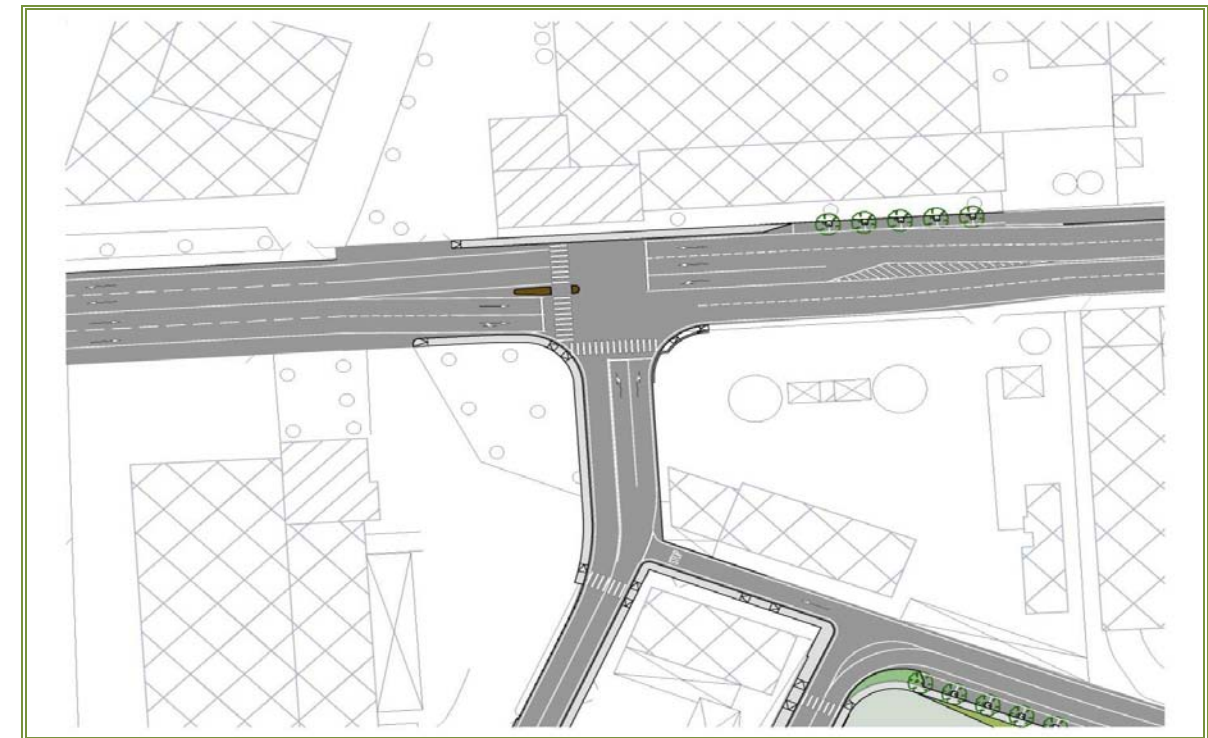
Planimetria Svincolo Vigasio Nord Nodo Via Gioia – 2a Traversa
